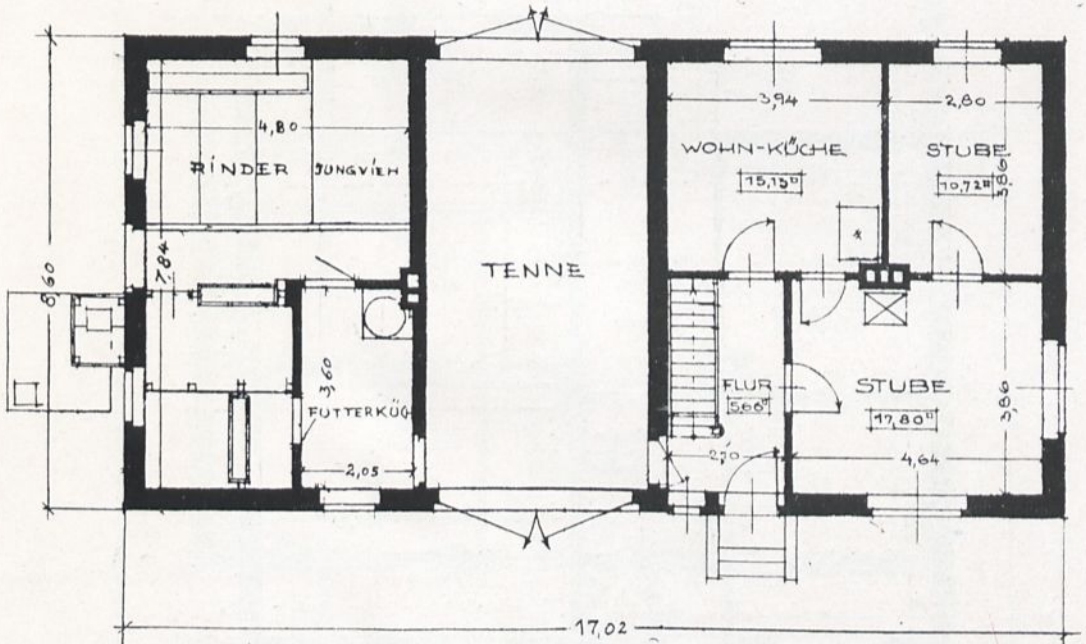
Wohn- und Stallgebäude mit Scheune nach Typ „A 8“
